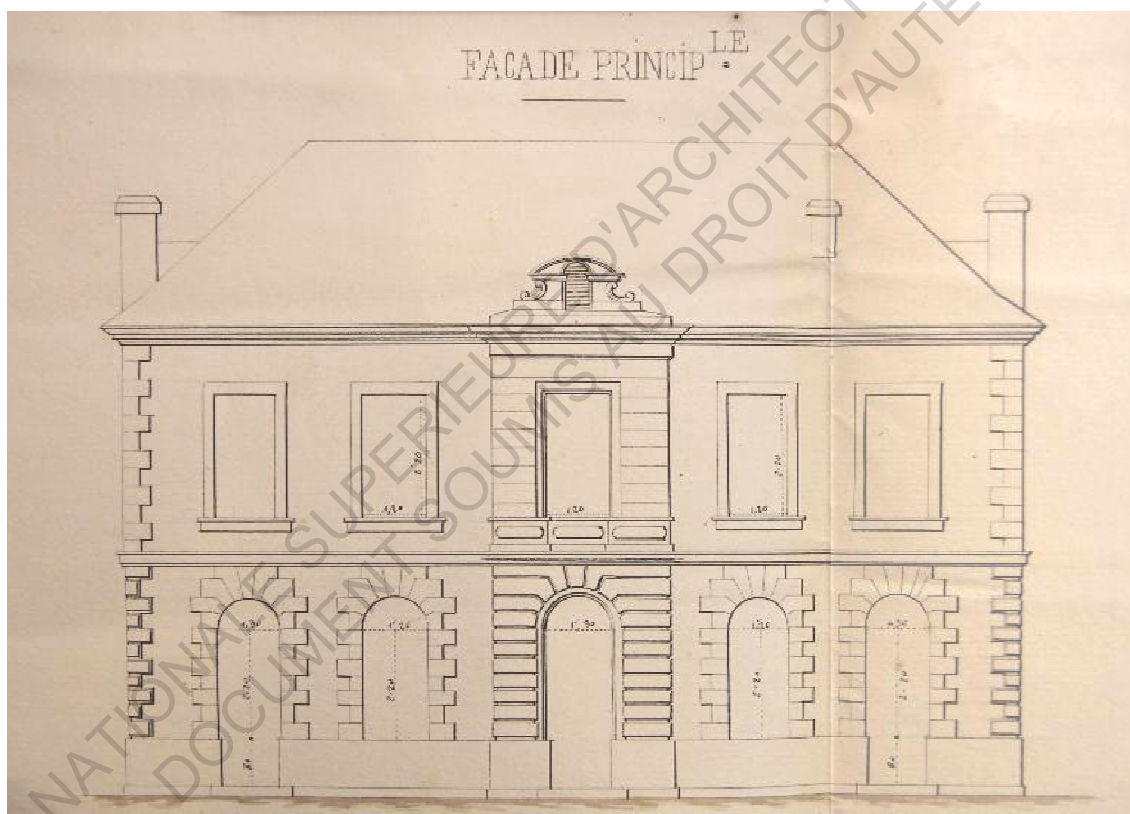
Projet d'un bâtiment pour mairie et école de Plougven (29), architecte d'arrondissement à Morlaix le 19 avril 1849. Plan de façade principale (AD29 – 2O1314).
